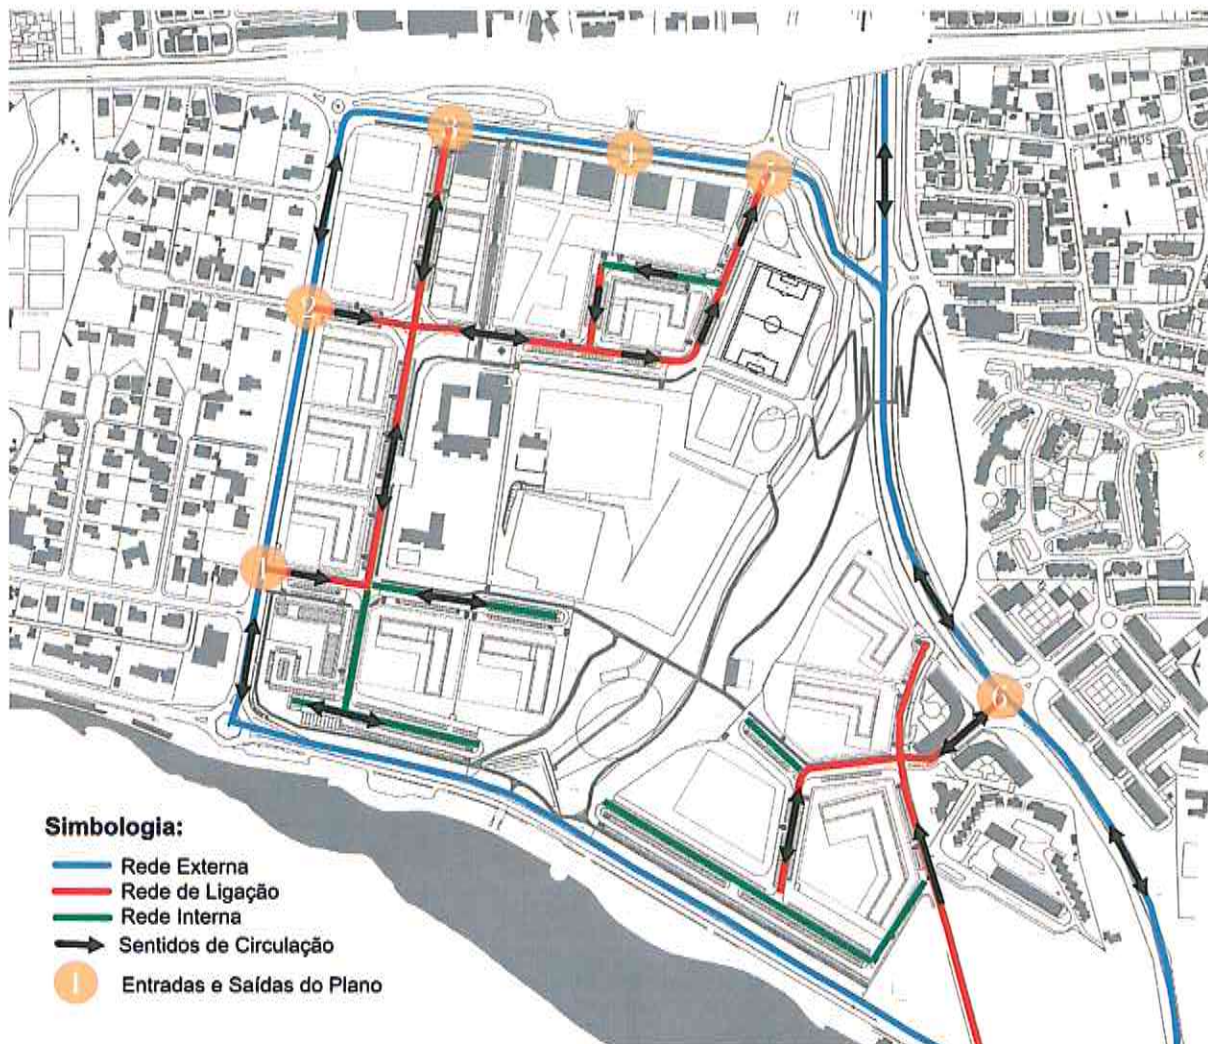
Planta Geral com atualização do Plano de Pormenor
